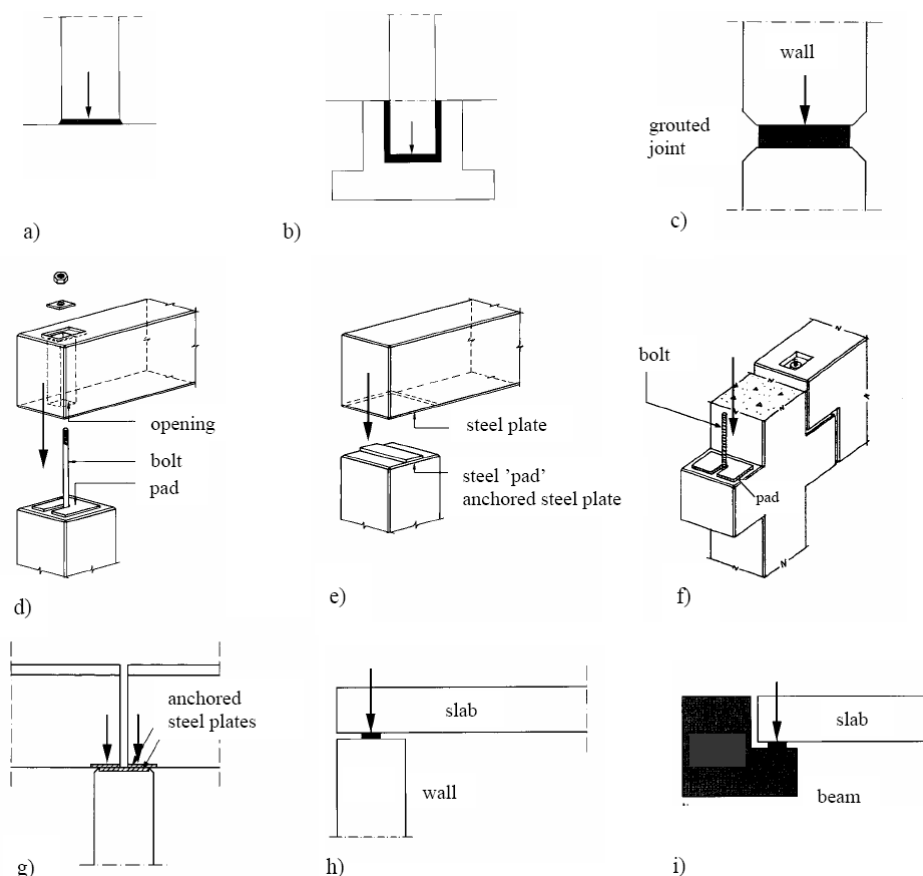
Ligações estruturais típicas em betão pré-fabricado sujeitas a forças de compressão (FIB, 2008)
